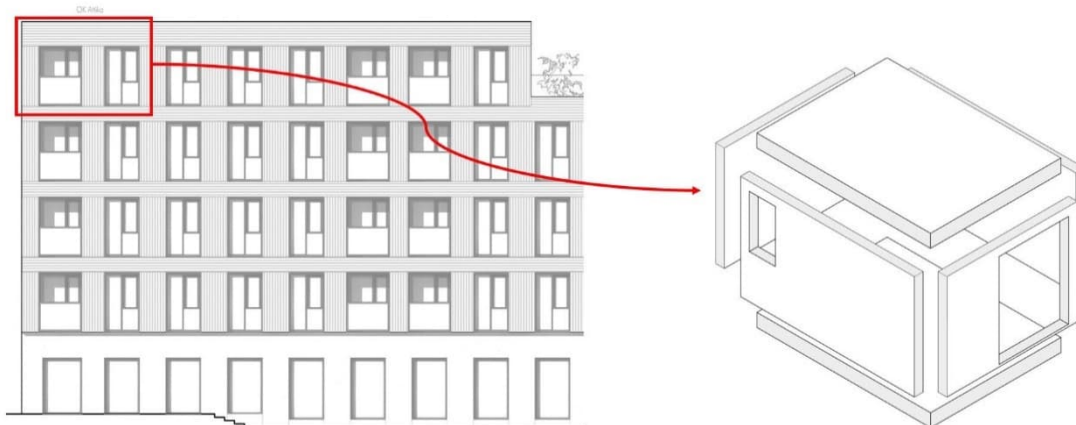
Planungsprozess für einen Teilausschnitt eines mehrgeschossigen Holzbaus
